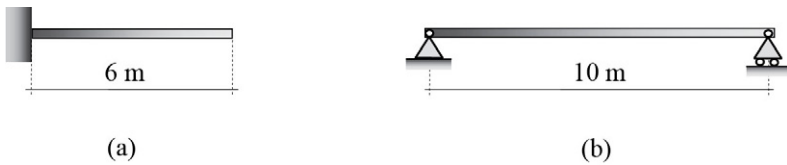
Vigas em balanço e viga biapoiada.
